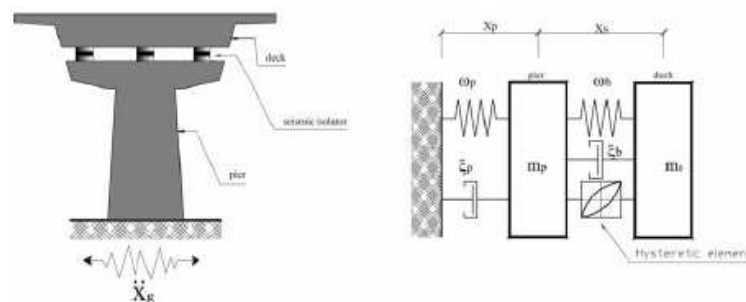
Modellazione del sistema pila-isolatore-impalcato
